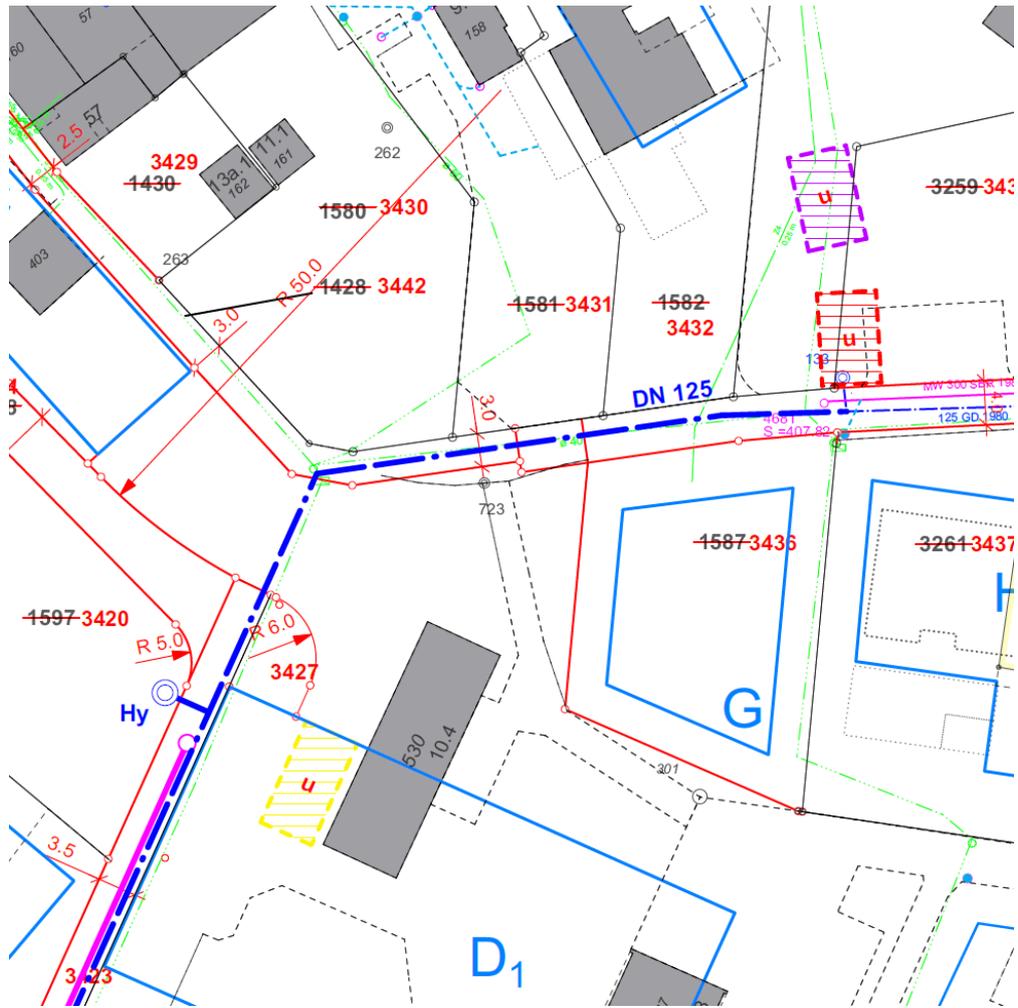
Geplante Standorte Ersatz Trafostation EKZ (Plan Erschliessung Werkleitungen)
